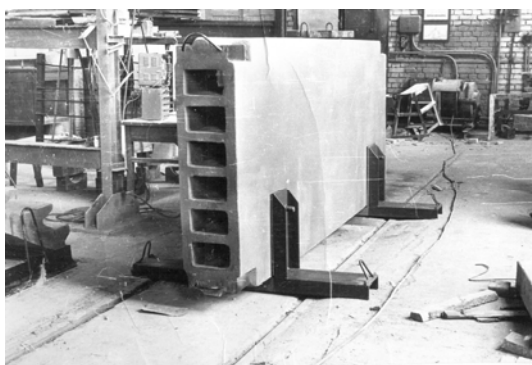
Дымоventилиционная панель из поризованного бетона с прямоугольными пустотами
